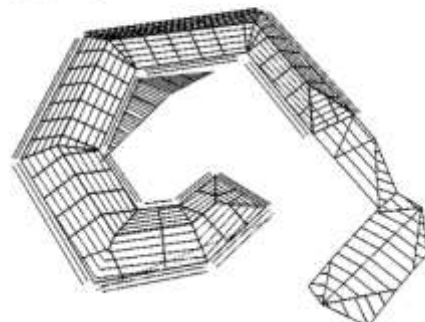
Sistem struktur rangka konstruksi baja.
